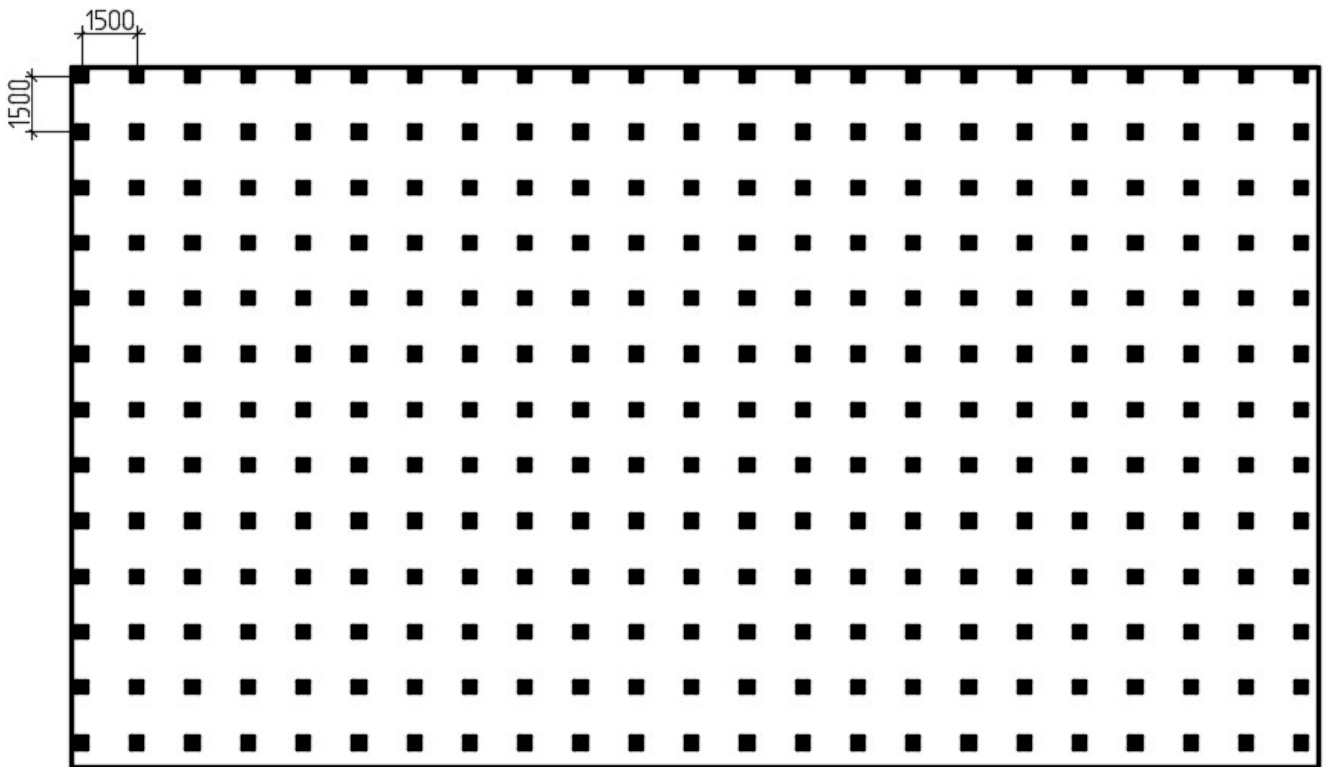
Опалубочный чертеж монолитной плиты фундамента
